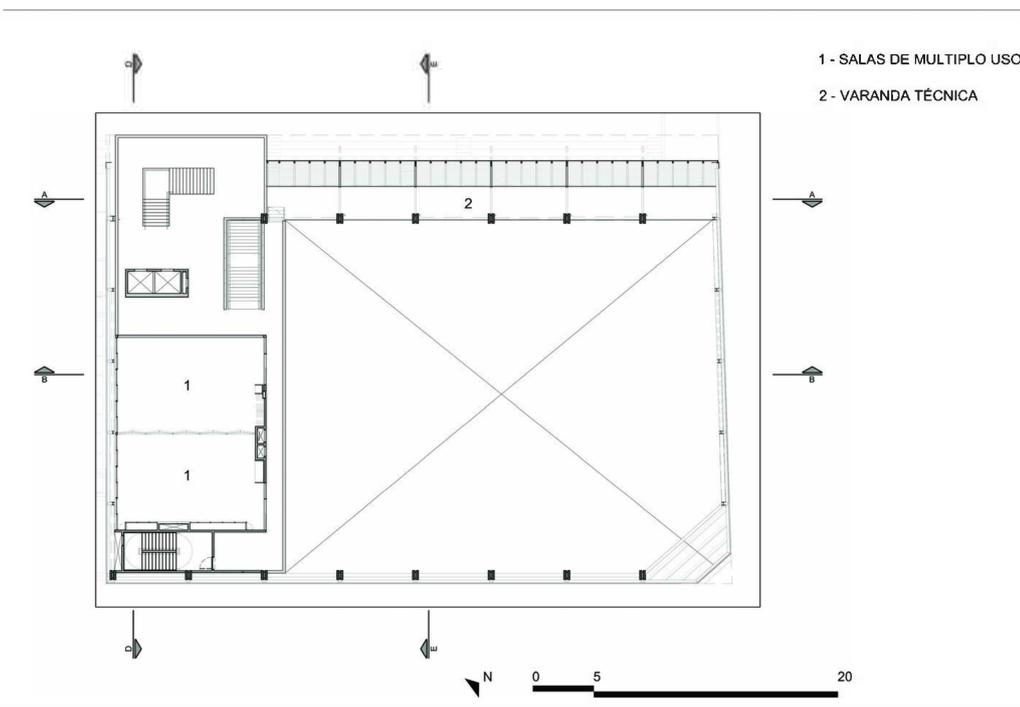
Soluções Espaciais – Planta Baixa do 2º Pavimento
